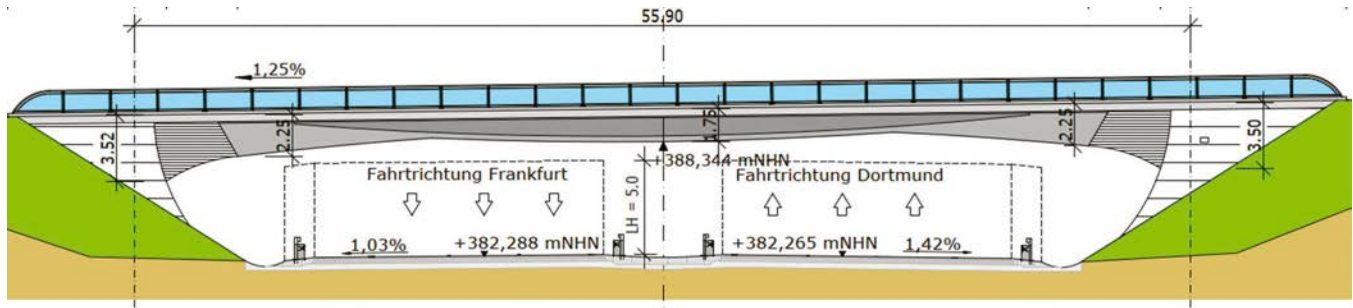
Variante 4 – Spannbeton-Rahmentragwerk mit Betonfertigteilen
